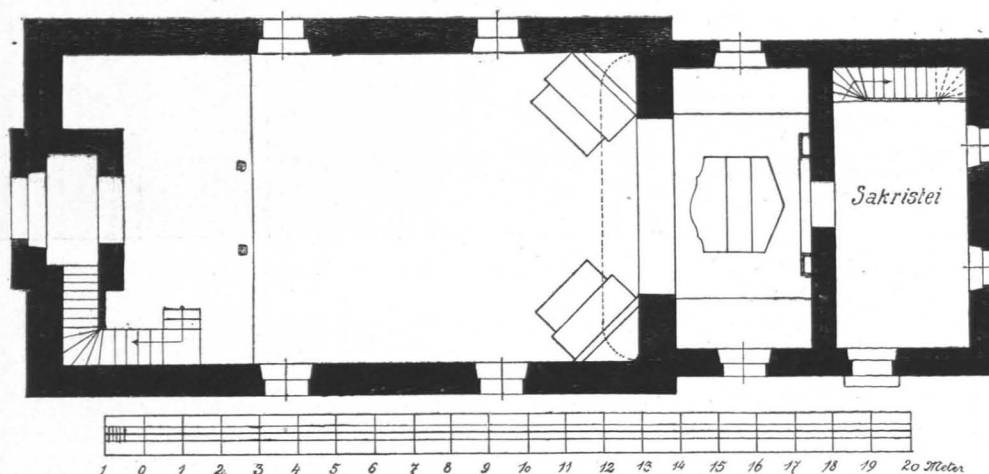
Hintersee, Pfarrkirche, Grundriß 1:200 (S. 221)
